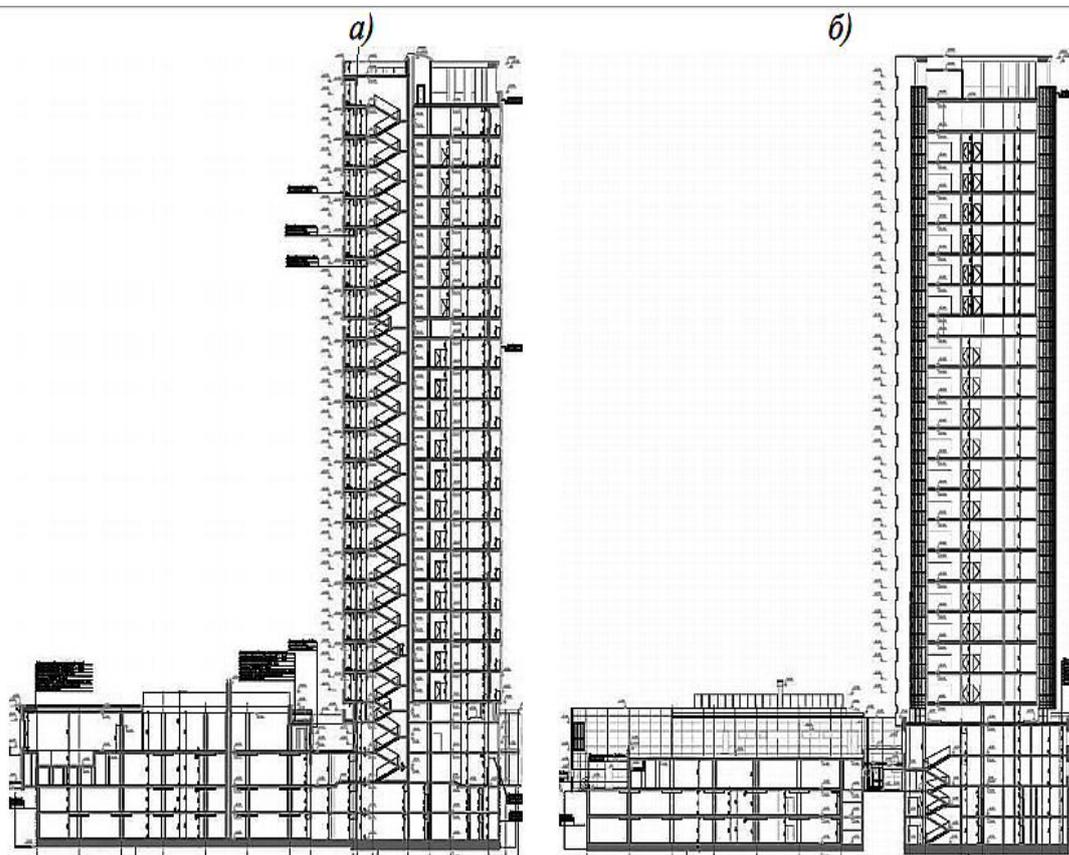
Поперечные разрезы по зданию: а – 1-1 и б – 2-2.
